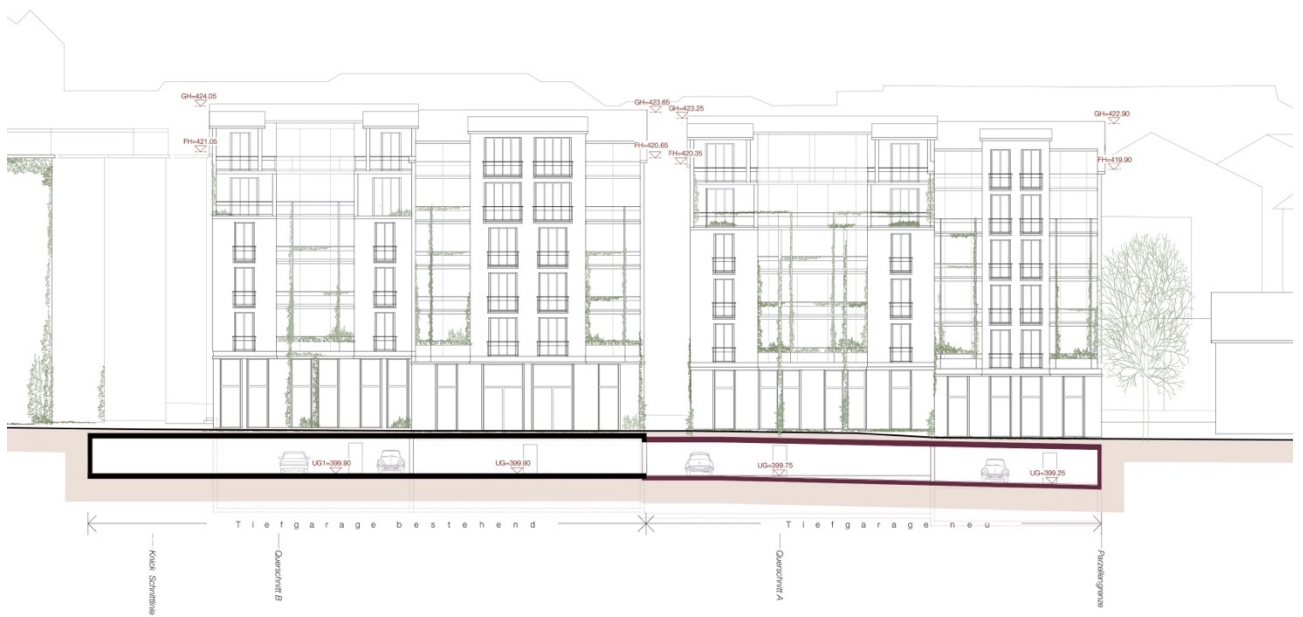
Ansicht Fassaden Alleestrassen, Thalmann
